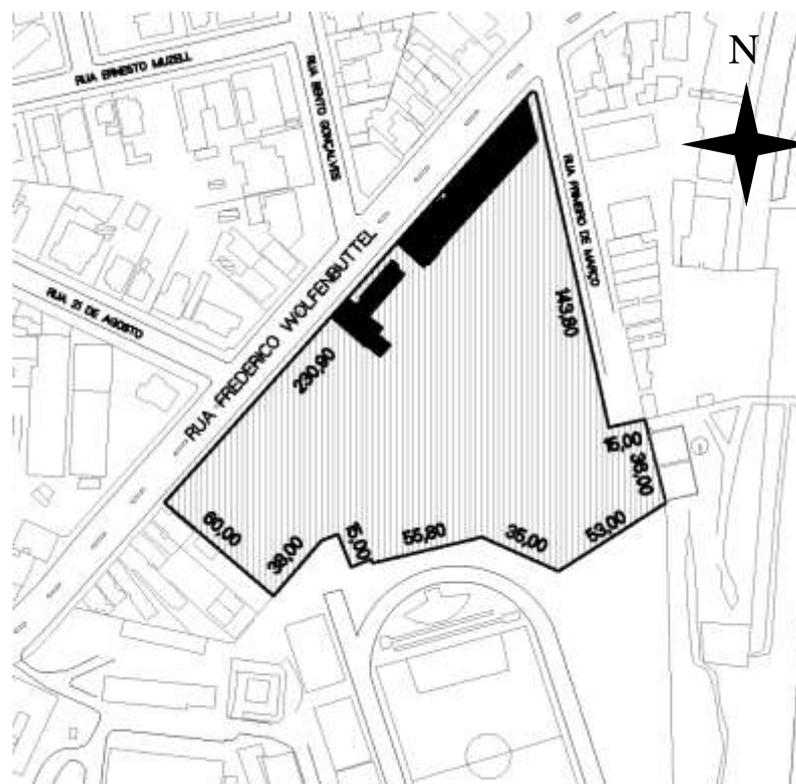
Dimensões do lote e construções existentes (adaptado de PMSL,2010)
